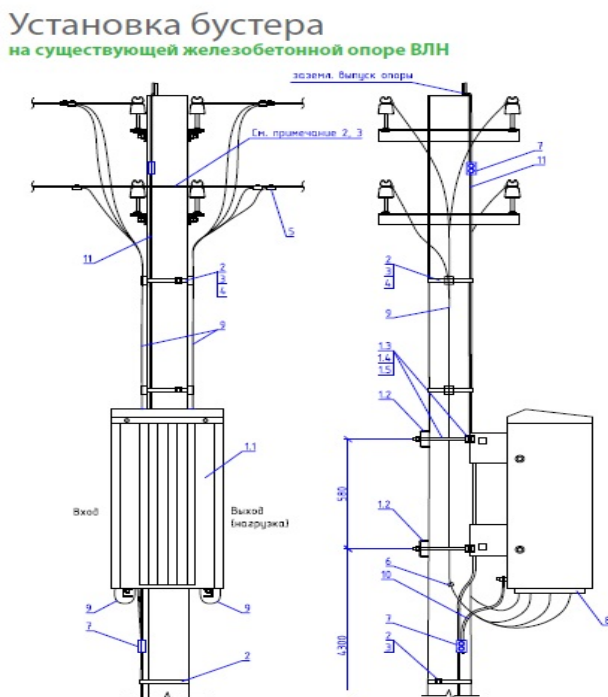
Схема установки бустера на железобетонной опоре ВЛН
